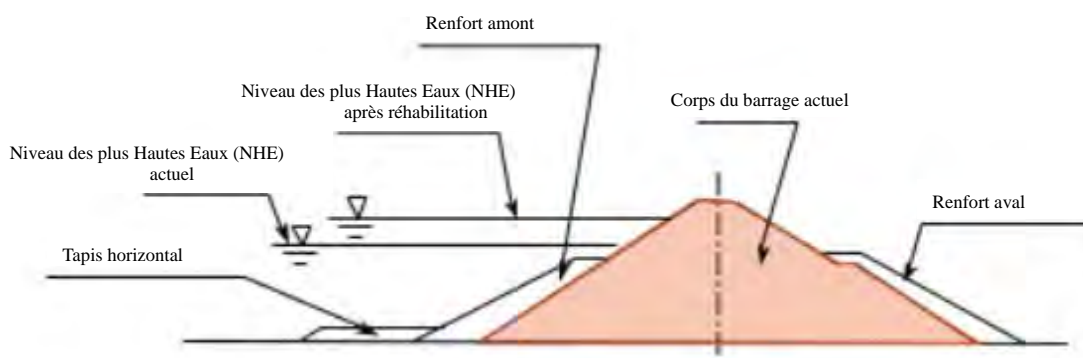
Plan général du projet de réhabilitation du corps de barrage
